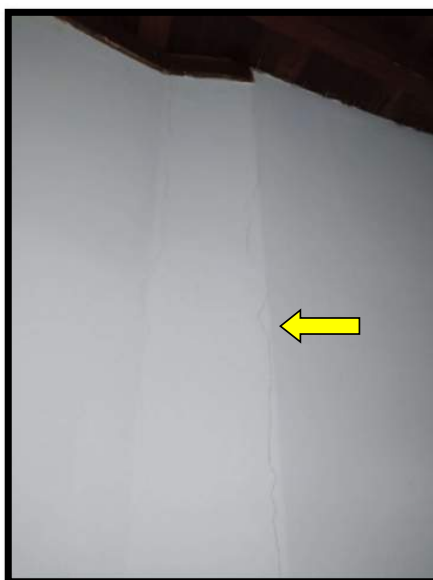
Desligamento entre elementos – pilar x alvenaria (Museu da BM).
